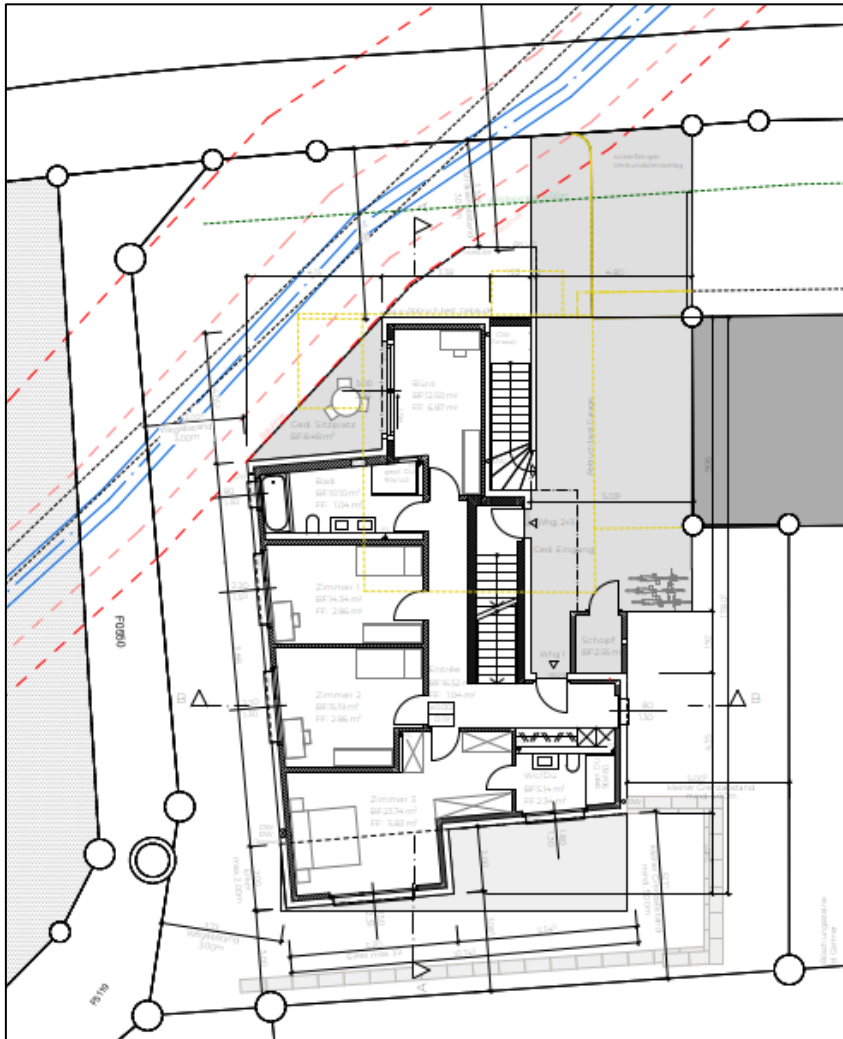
Grundriss des geplanten Neubaus, Erdgeschoss
